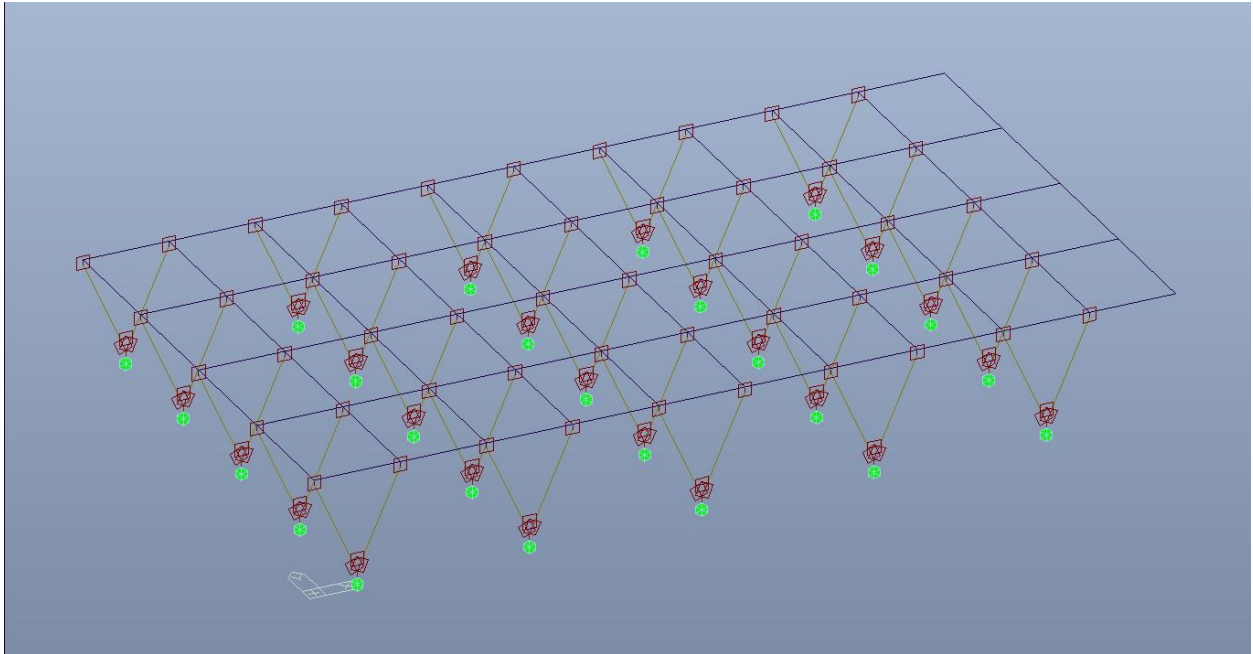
Sovrastruttura zona viaggiatori – Schema statico Vista 1
